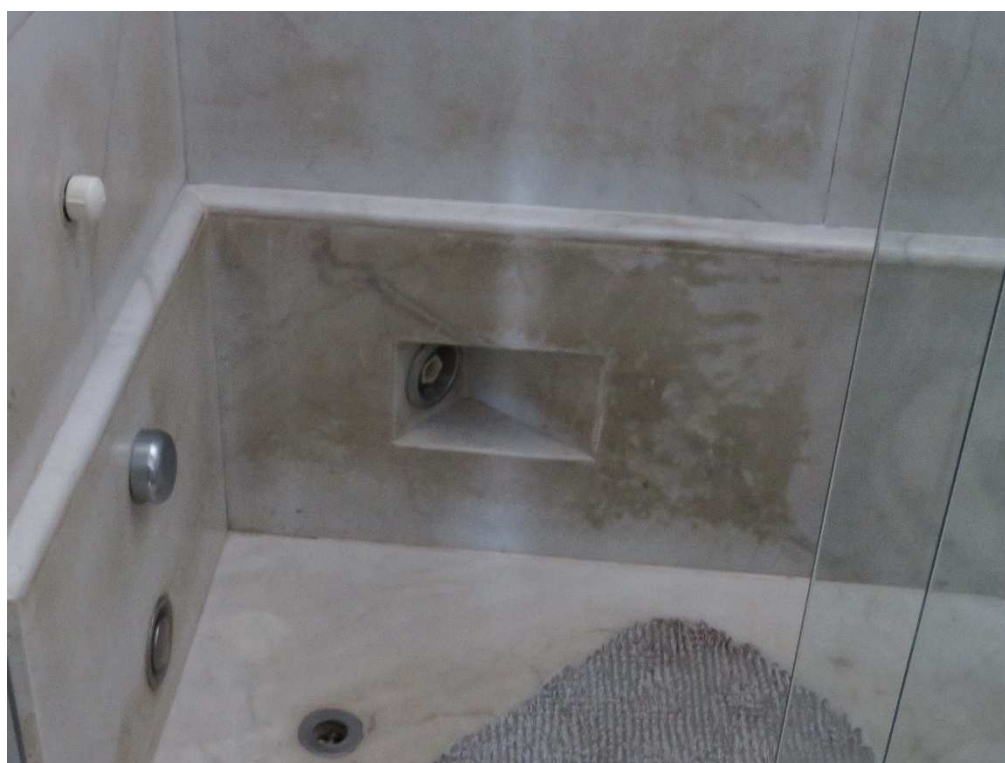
No detalhe da foto anterior notam-se os revestimentos desgastados e que a banheira foi eliminada e transformada em box para chuveiro
